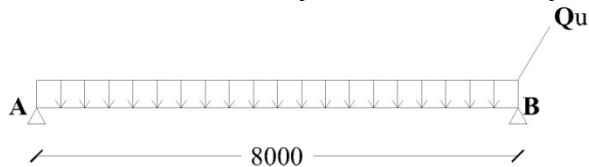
Balok anak lantai atap yang ditinjau
